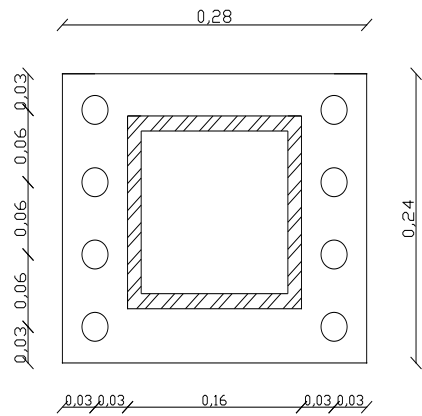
Ligação aparafusada do banzo inferior em RHS 160x160x12.5
